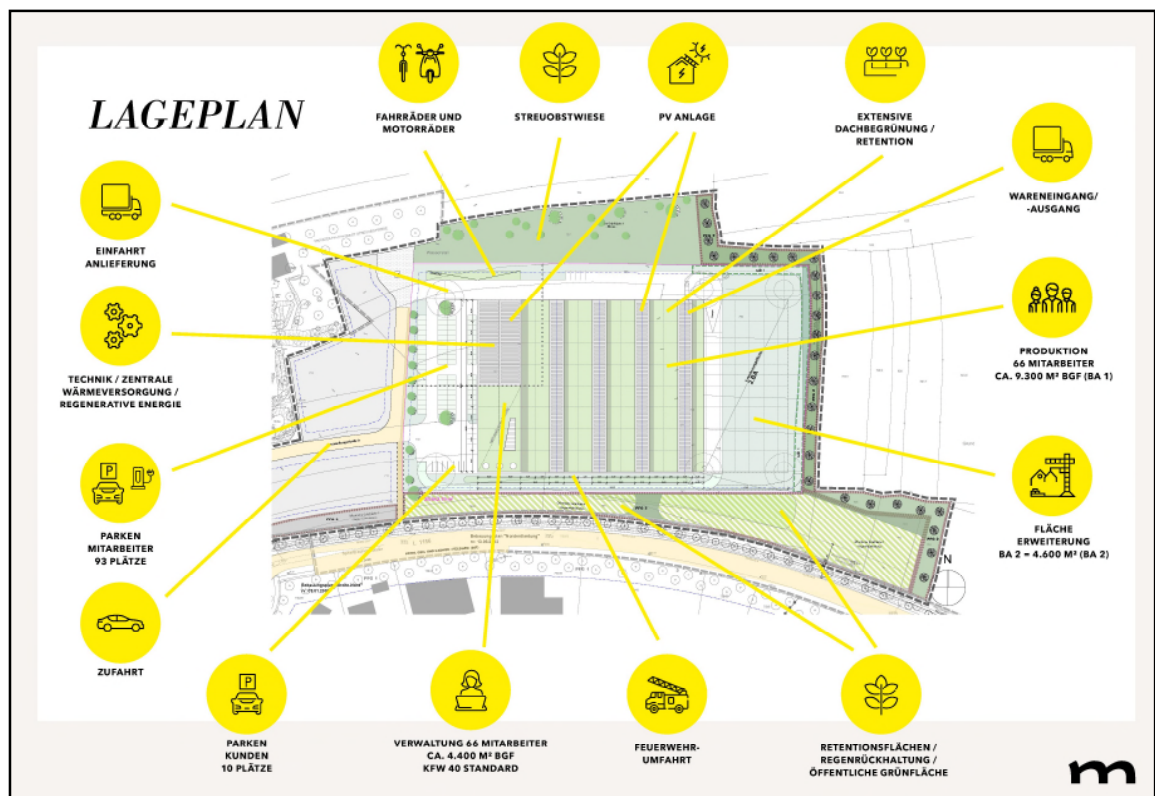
Planung Firmenflächen OSPA, unmaßstäblich [Quelle: Merz Objektbau]
